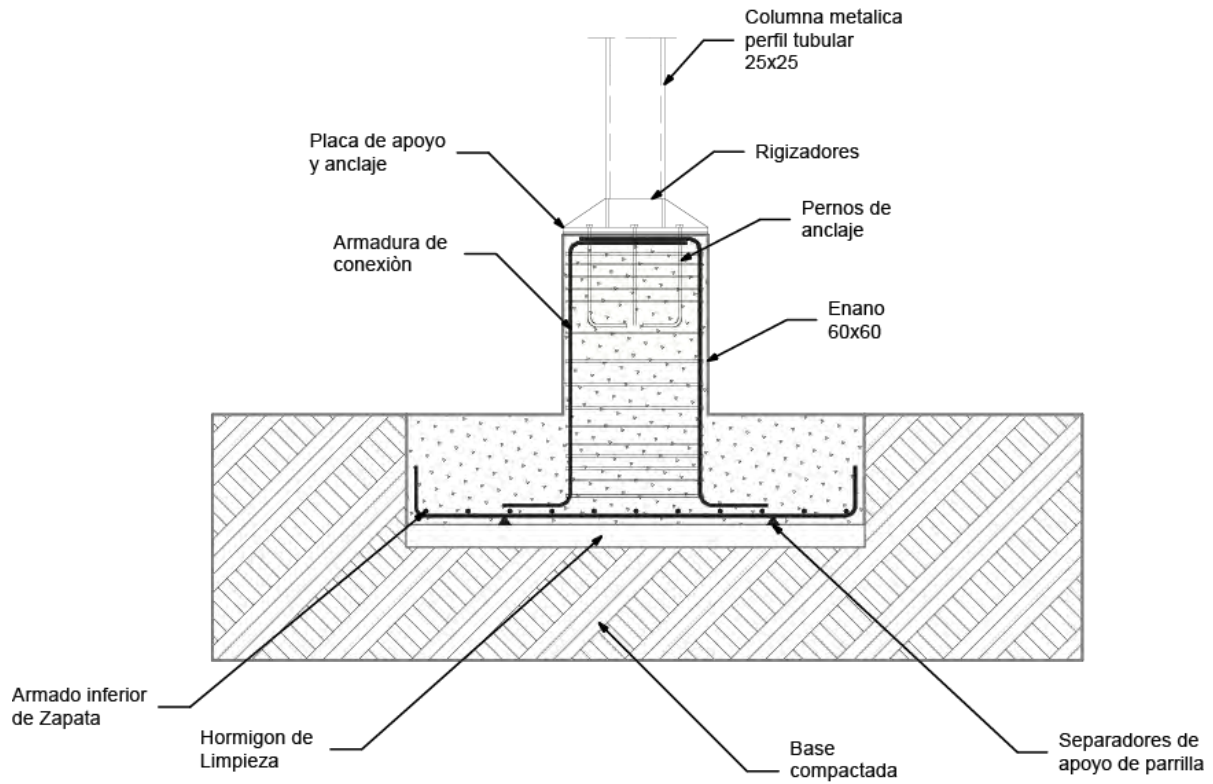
Detalle sección columna primer piso Bloque C (Ala oriental). Fuente: Elaboración Propia.
